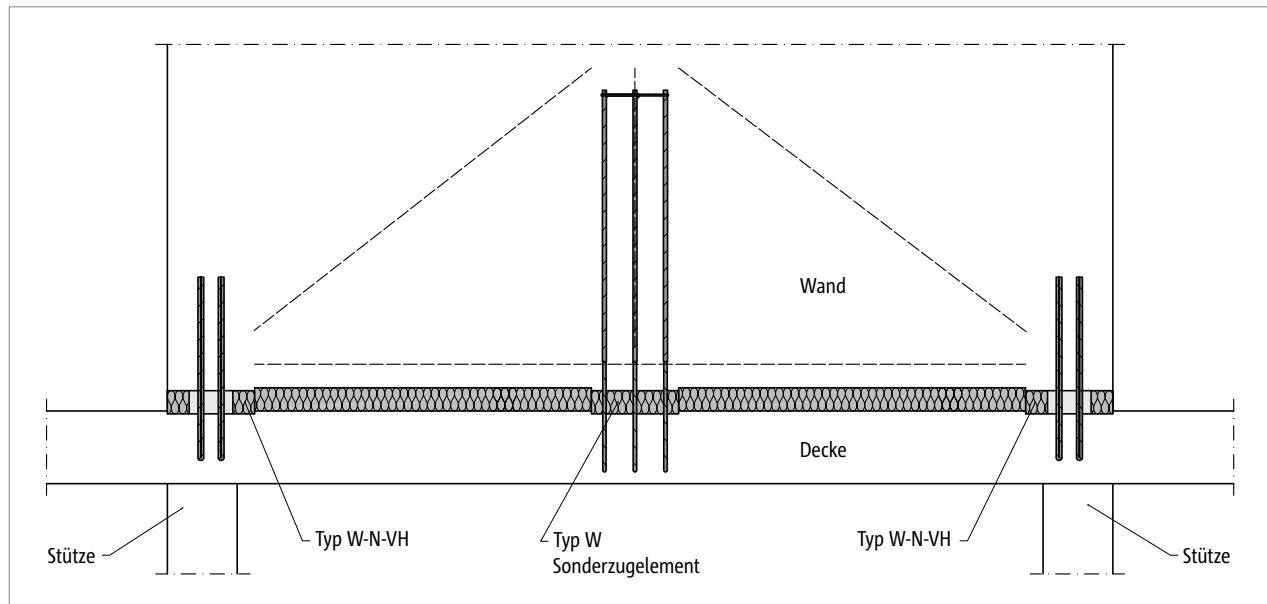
Schöck Sconnex® Typ W: Kombinierte Produktvarianten für den Anschluss eines wandartigen Trägers mit Deckenaufhängung
